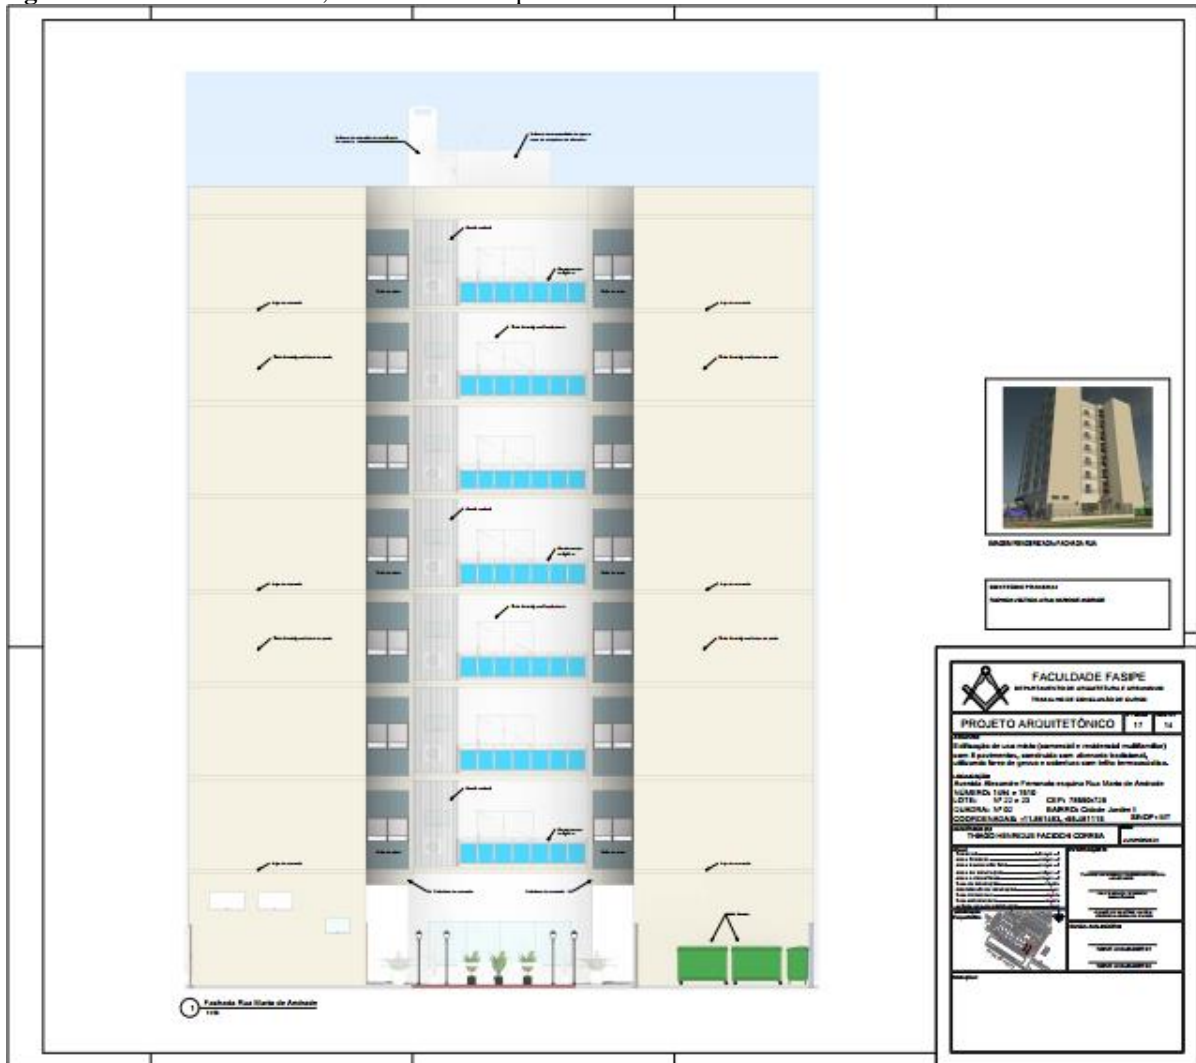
Prancha 13 de 17, Fachada voltada para a avenida Alexandre Ferronato.
